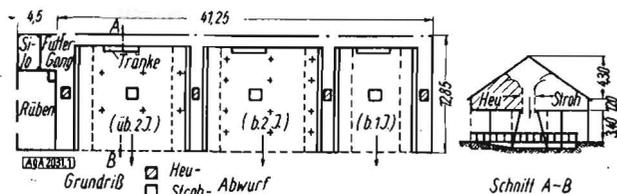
Jungvieh-Offenstall mit deckenlastiger Lagerung auf der Grundlage des Typenstalles für 60 Kühe
